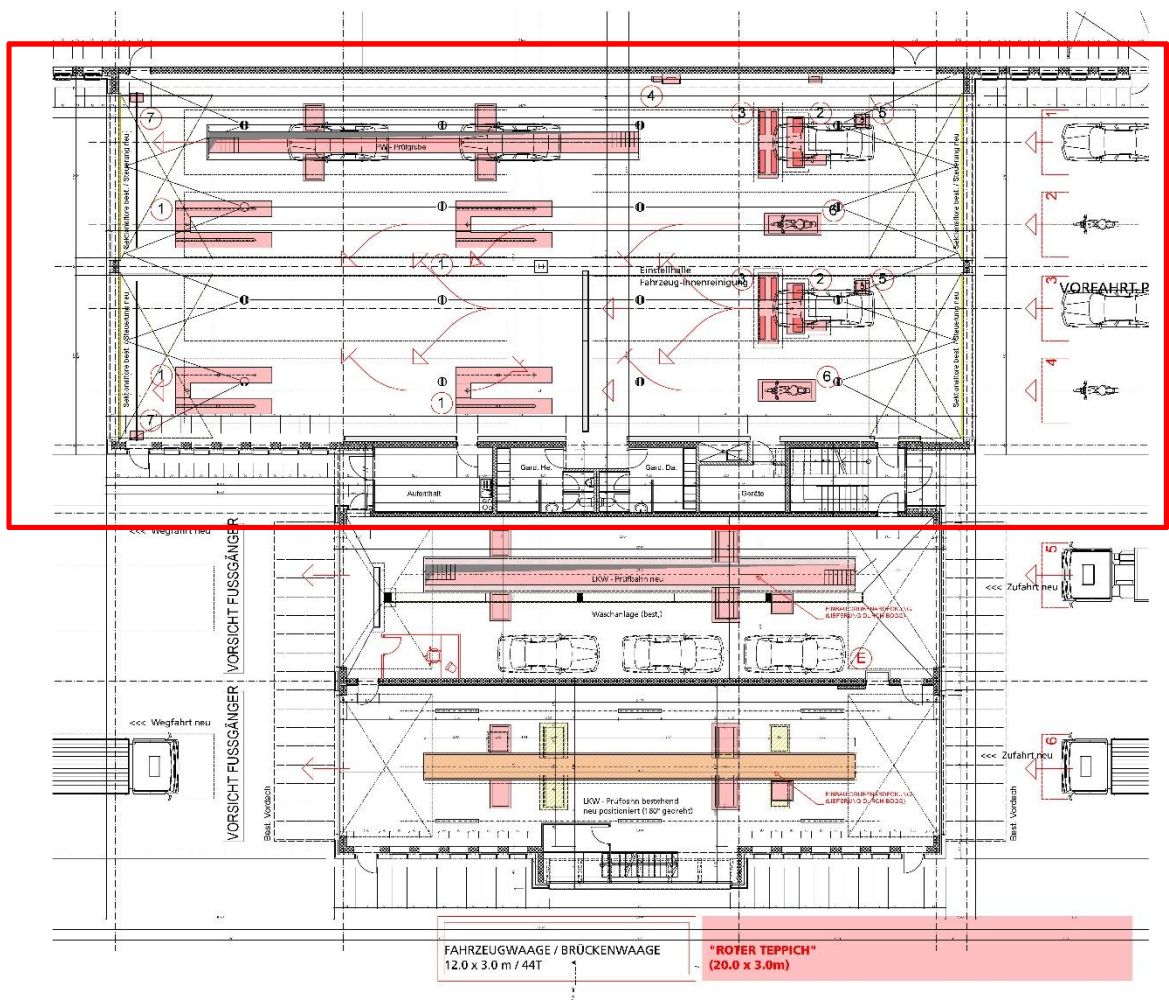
Grundrisslayout Prüfhalle 1, Erdgeschoss (Halle nicht unterkellert)
